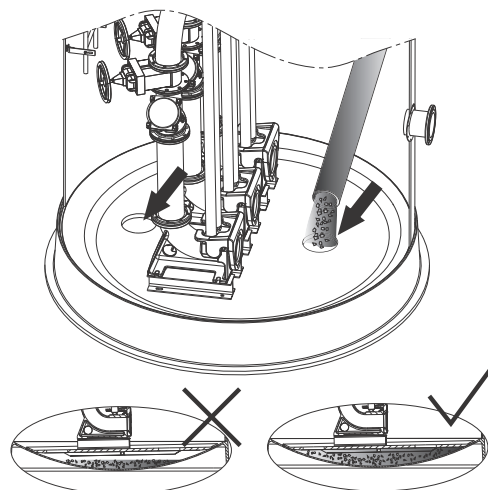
Hur det ihåliga utrymmet ska fyllas med betong
